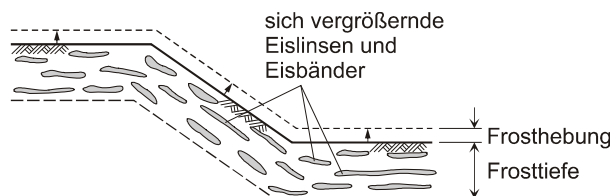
Hebung des Bodens infolge sich vergrößernder Eislinsen und Eisbänder
